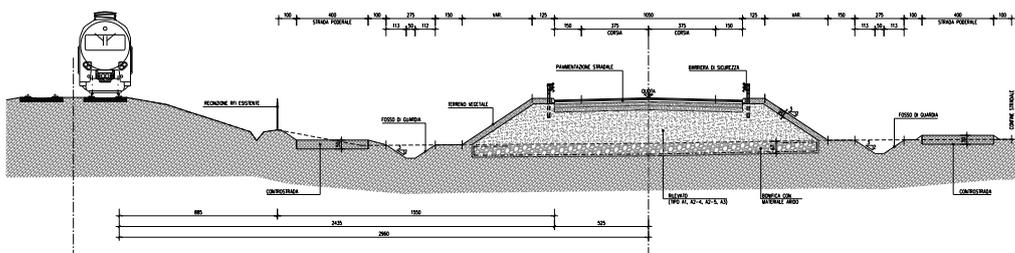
Tratto Svincolo di Via Cà Brusà - Svincolo di Castel d'Azzano - Sezione Tipo
